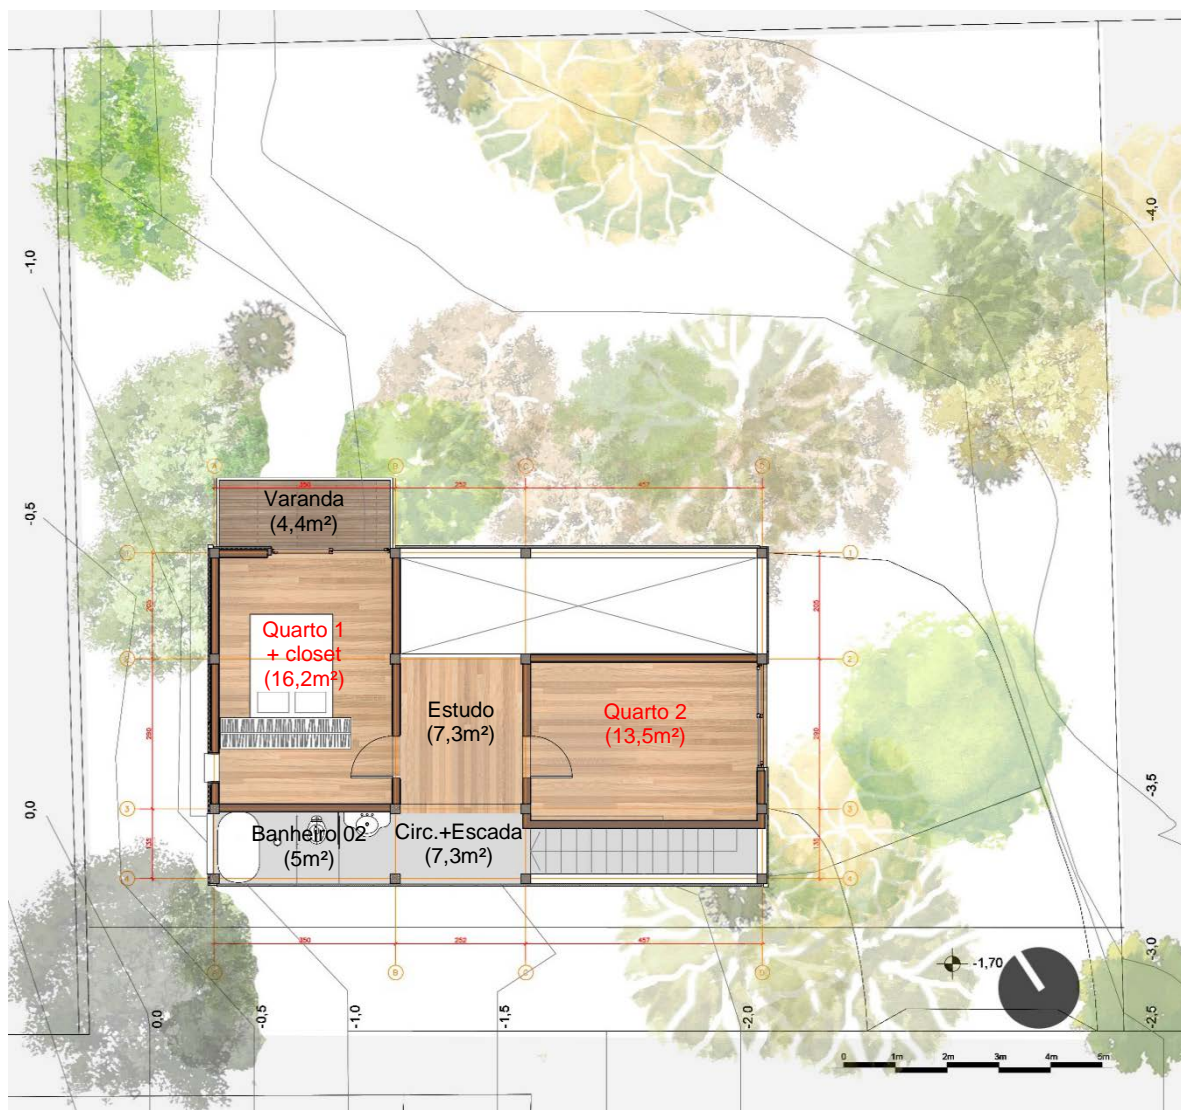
Planta baixa primeiro pavimento. Zonas condicionadas em vermelho
